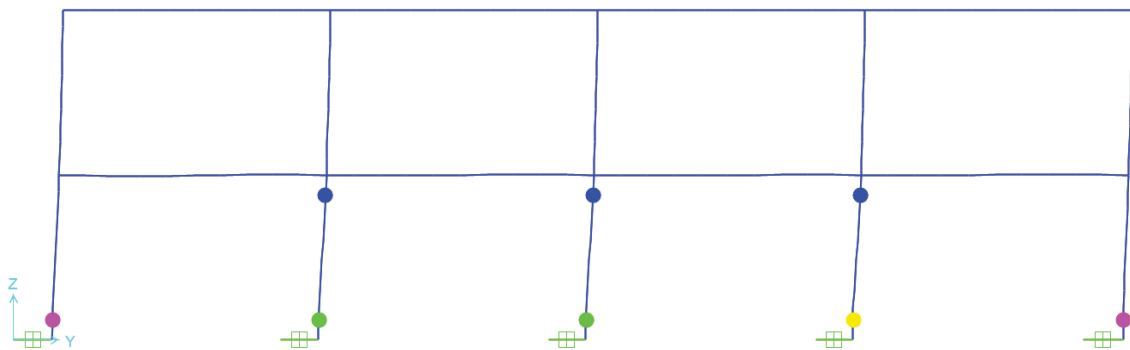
Secciones de columna en estado de Agotamiento – Aislado
